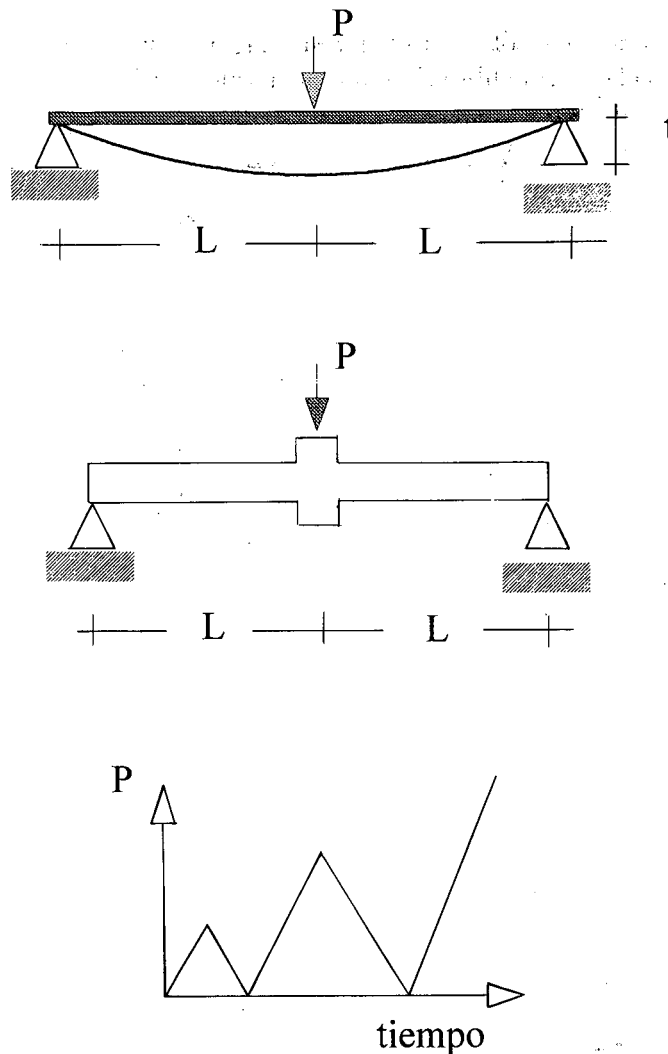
Ensayos de identificación del modelo. a) Viga simplemente apoyada, b) Modelo de junta viga-columna, c) Esquema de la sollicitación
